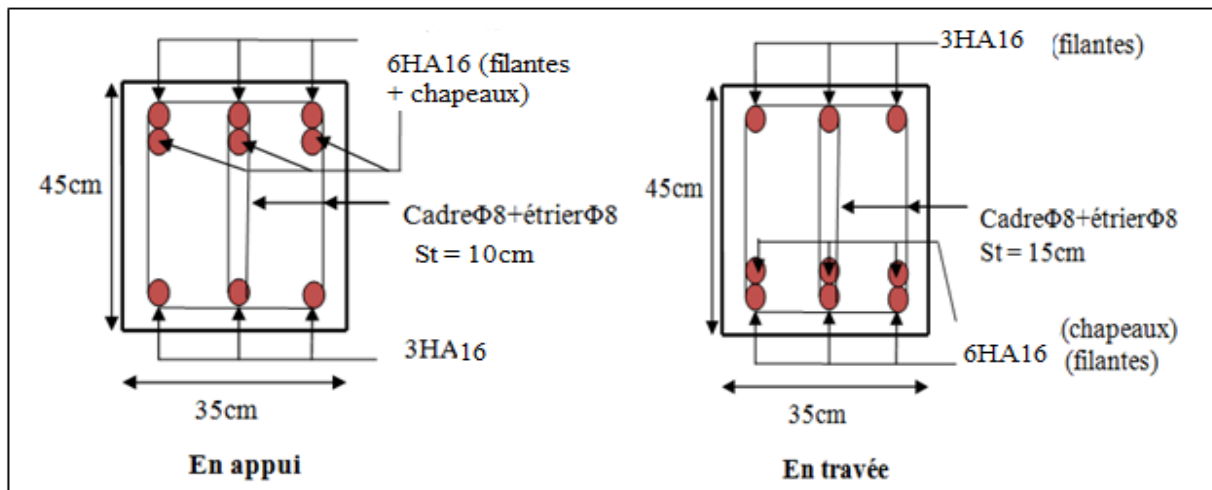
Exemple de Schéma de ferrailage d'une poutre principale.
